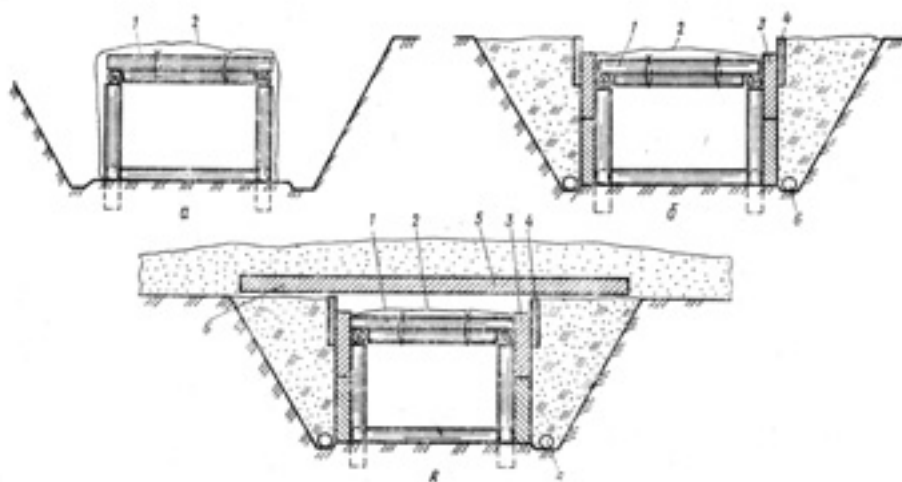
Последовательность возведения БВУ податливой конструкции из панелей перекрытий: а – отрывка котлована, устройство рамы, гидроизоляция; б – установка стеновых панелей и их засыпка; в – укладка плит и засыпка котлована; 1 – распорная рама; 2 – гидроизоляция; 3 – стеновая панель; 4 – деревянный щит; 5 – плита перекрытия; 6 – дренаж
